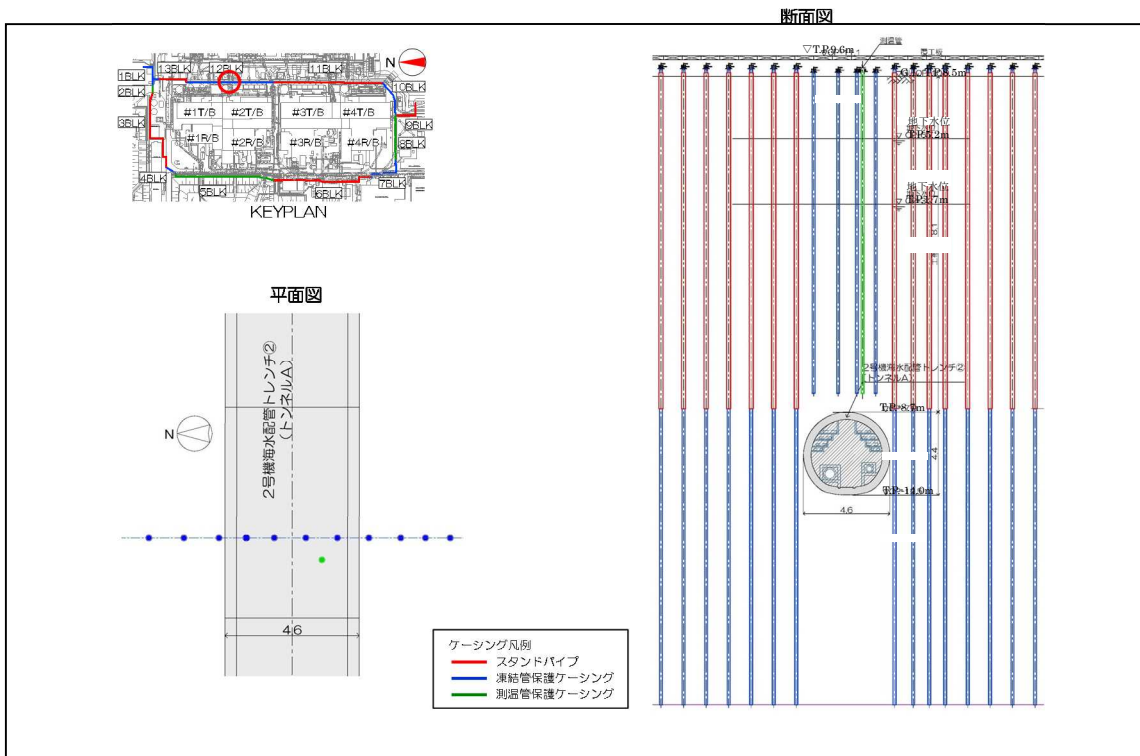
2号機海水配管トレンチトンネルA部 施工平面図・断面図
